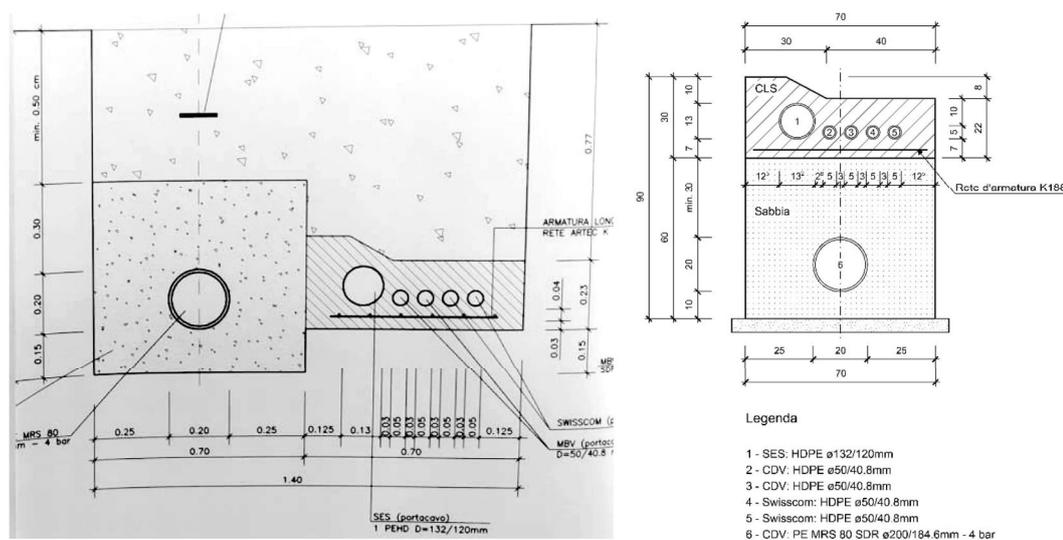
Sezione tipo del bauletto CDV esistente. Secondo piani d'archivio (sinistra) e sezione tipo considerata per il progetto livello PDE (destra)
